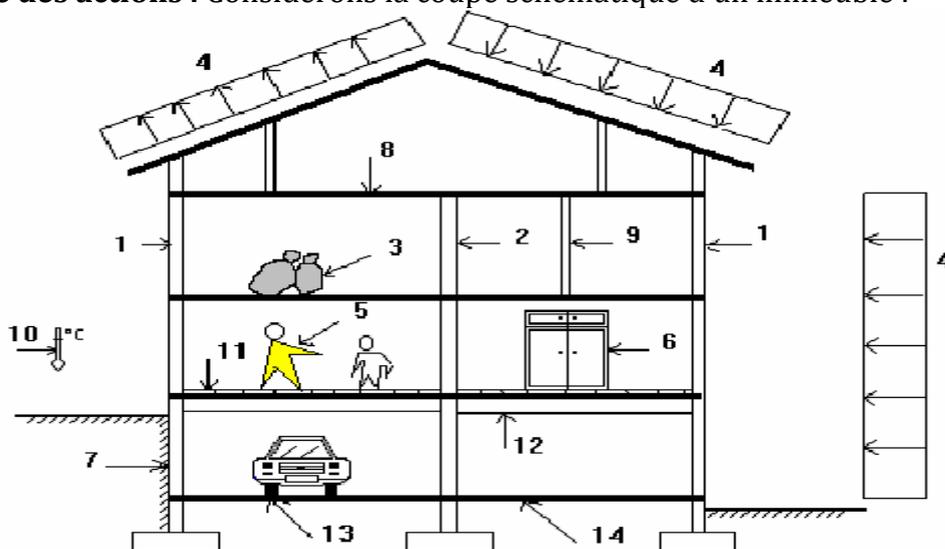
Coupe schématique d'un bâtiment à 4 niveaux.
